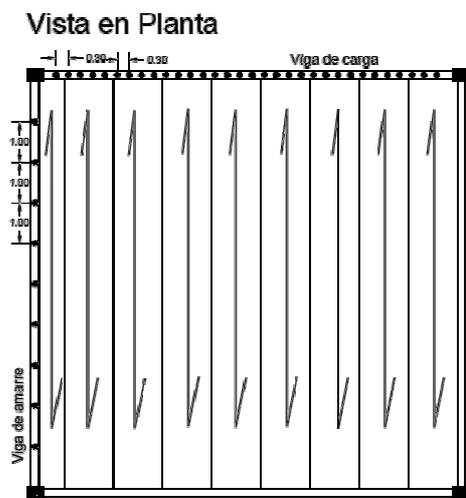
Vista en planta de la colocación de puntales para el sistema de losas pretensadas. Del autor
